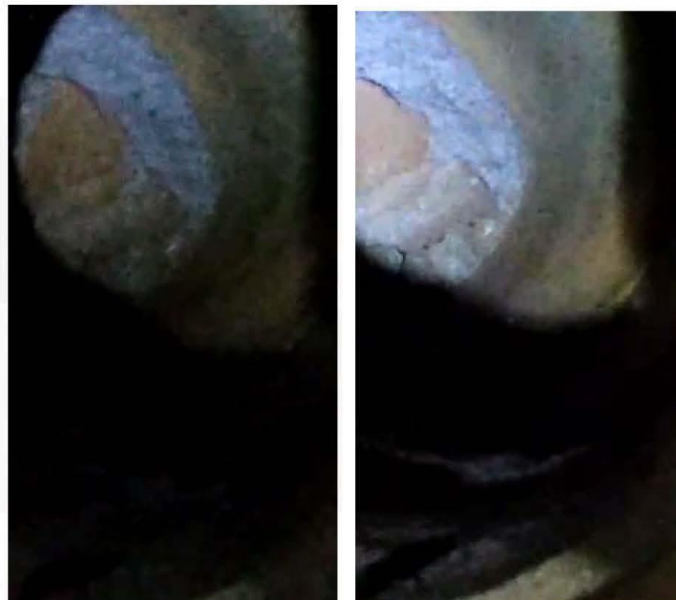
Concreto que escorreu para dentro da tubulação DN 400mm
